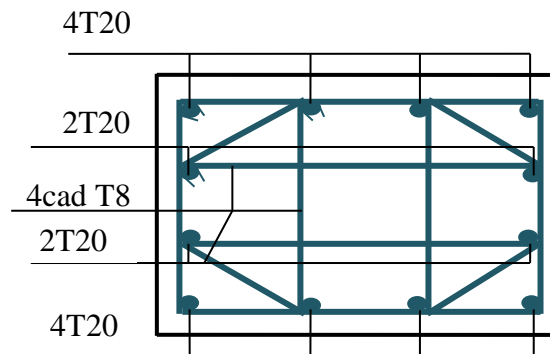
Ferrailage des poteaux des Sous-sol (70x70).
